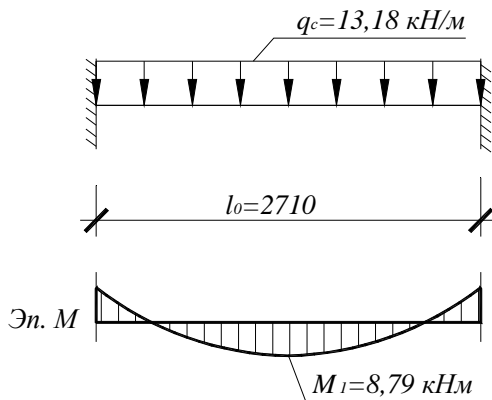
Расчетная схема полки плиты, эпюра моментов.
